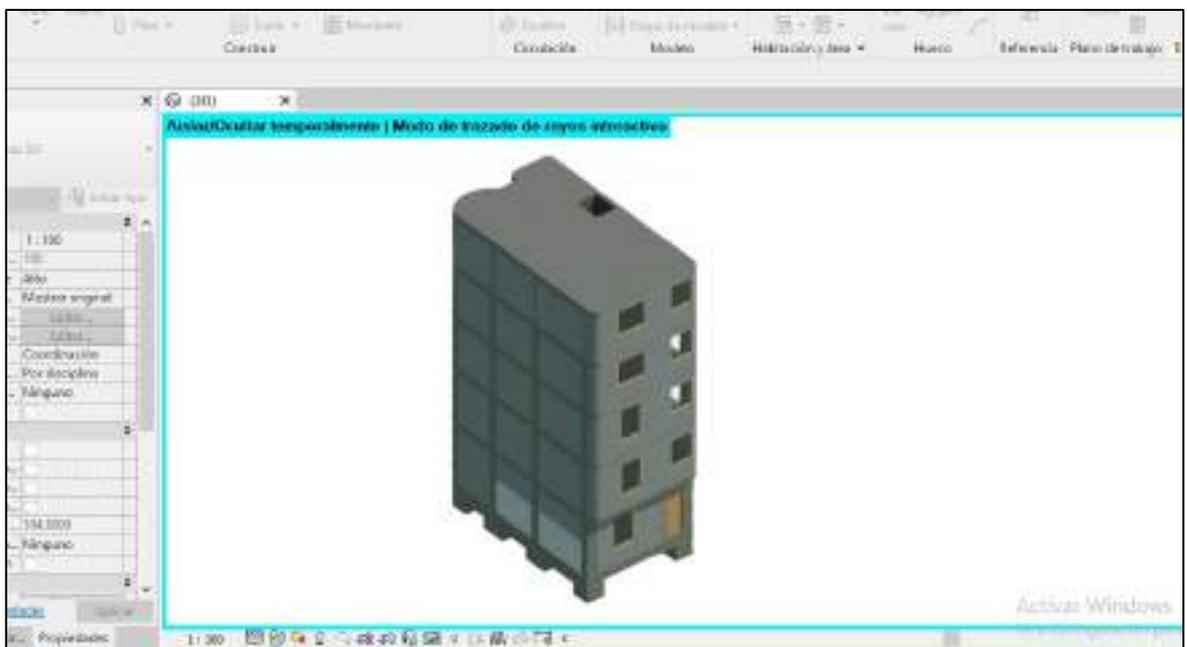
Se observa el modelado final de la estructura de la edificación.
